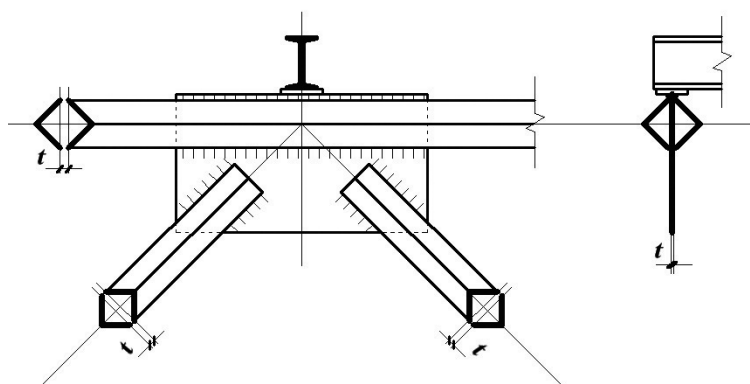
Стропильная ферма, сваренная из равнополочных уголков, поставленных под углом 45°
